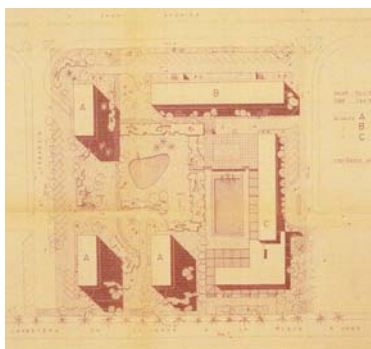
22: Plano de ordenación de una manzana dentro de la propuesta de Miguel Lopez Gonzalez, de Apartamentos y restaurante para la constructora Sudeste SL. 1958. San Juan, Alicante. Turismo y Arquitectura: La modernidad como respuesta. Vía Arquitectura,1: p. 24-42.
